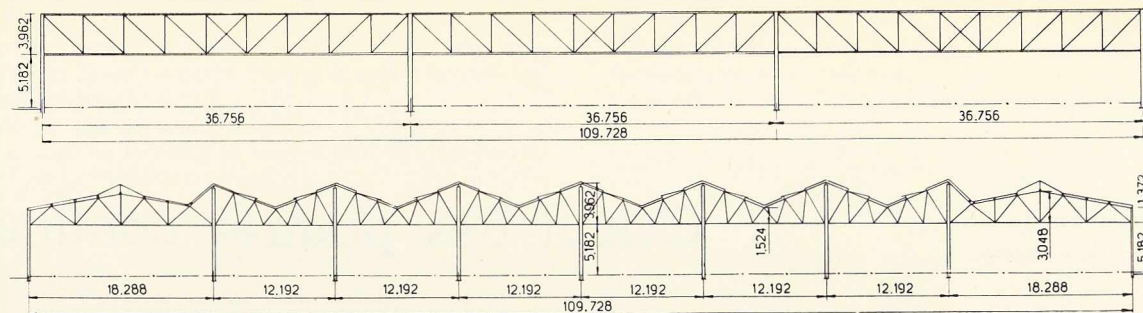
Charpente métallique des usines de la Tubewrights Ltd. à Kirkby. Coupes.
